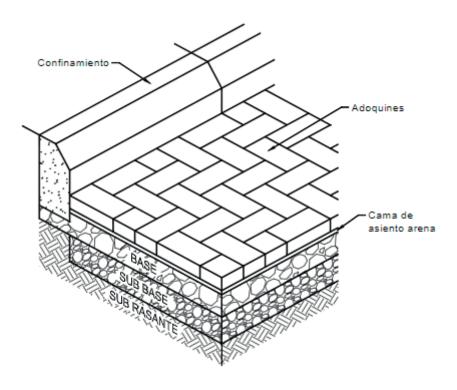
1. Estructura de un pavimento de adoquines en concreto
